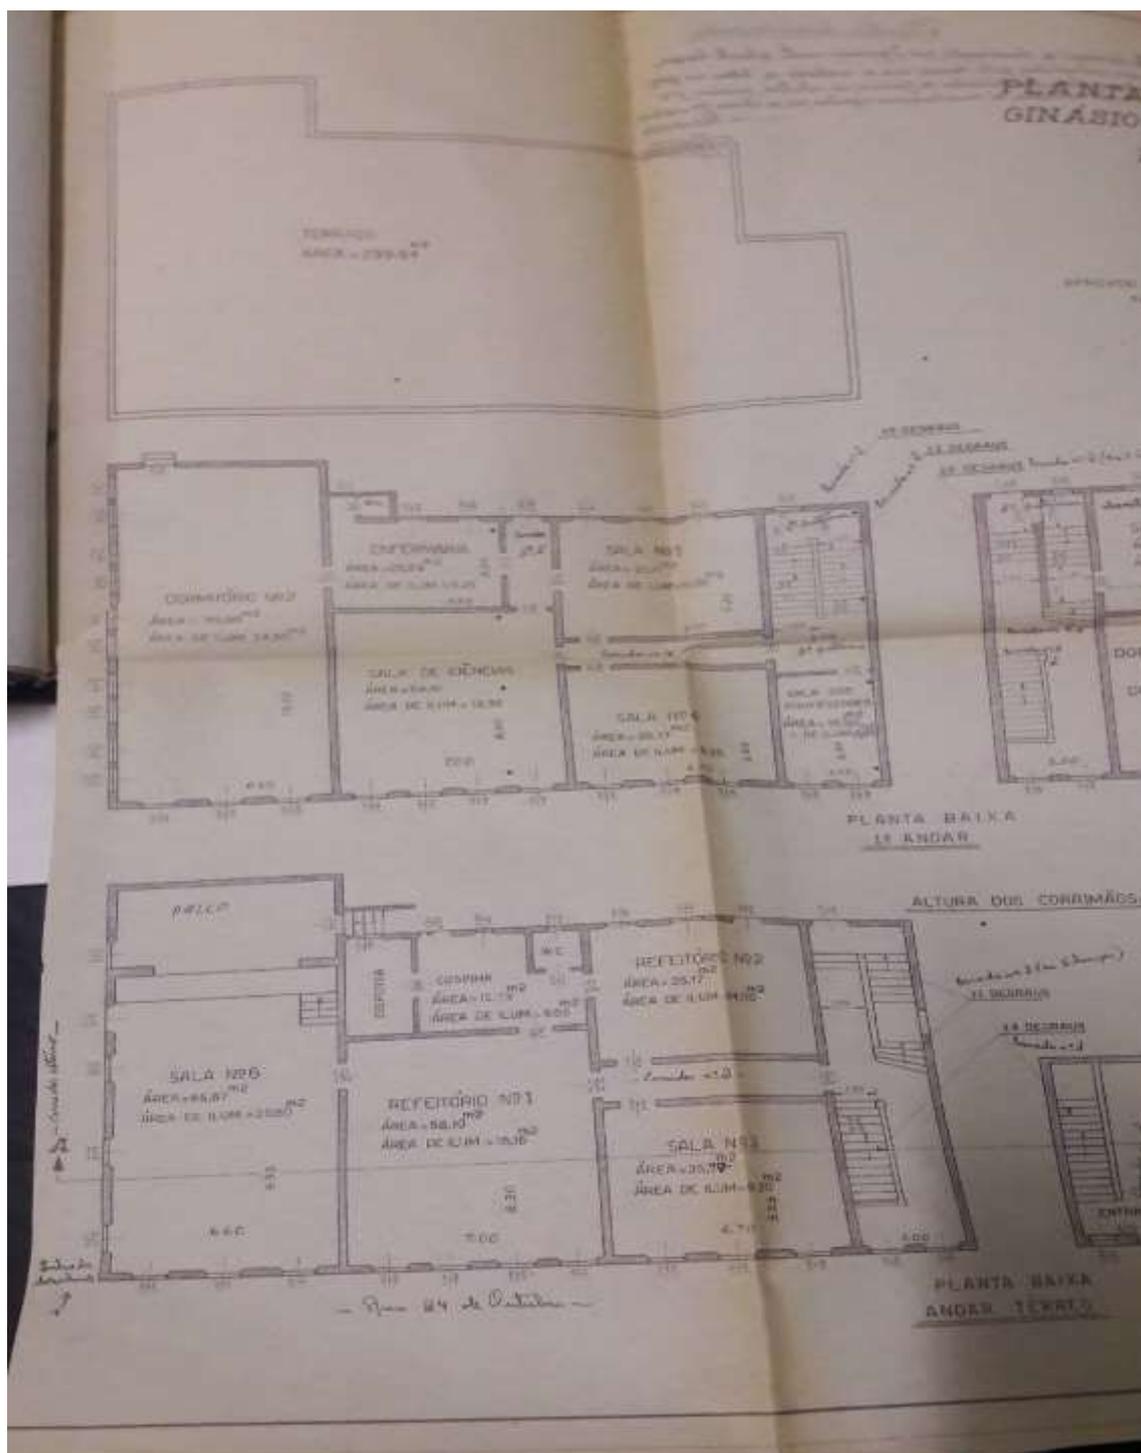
Planta baixa do segundo pavilhão do Ginásio Guilherme Gonçalves.
